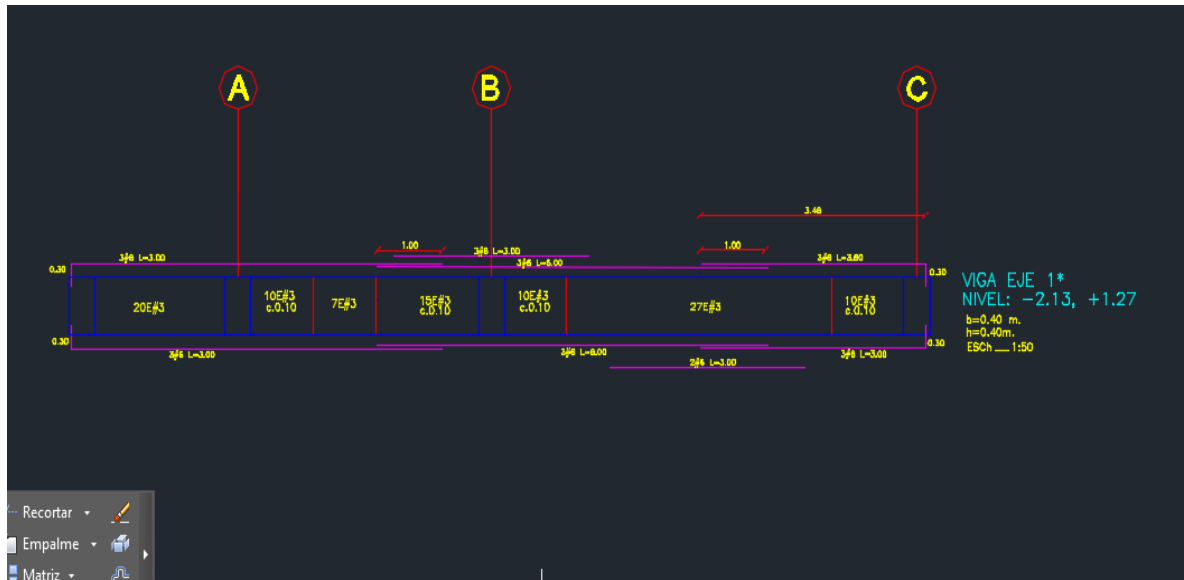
Plano de despiece viga eje 1*, losa entrepiso tipo.
